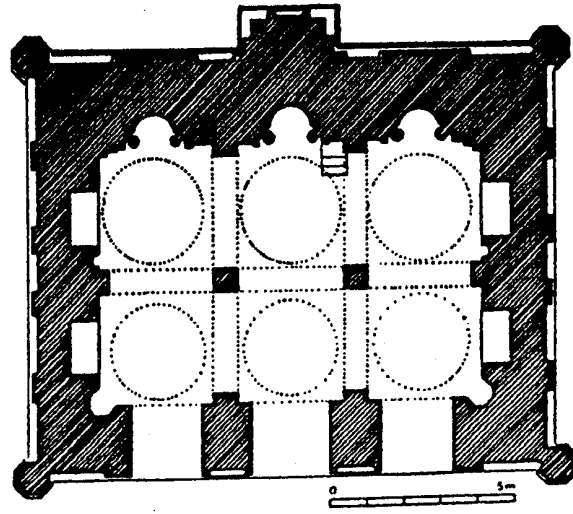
مسقط أفقي للجامع العتيق أو القديم في أدرنة
